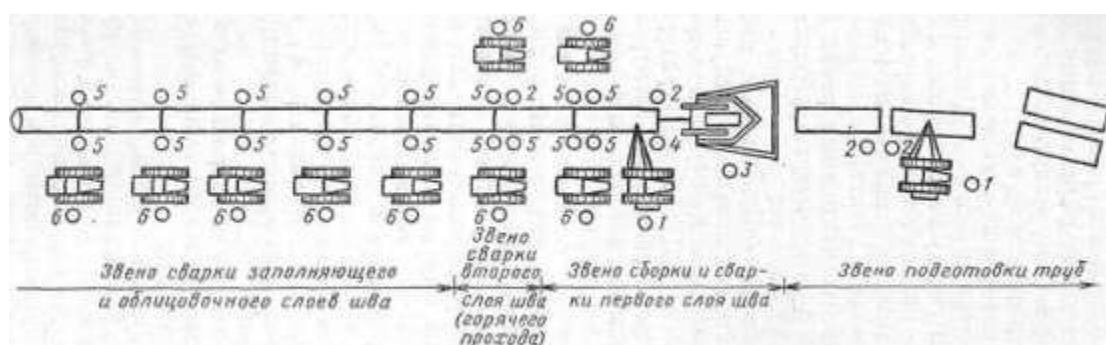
Схема проведения сварочно – монтажных работ поточно – расчлененным методом [4]:
